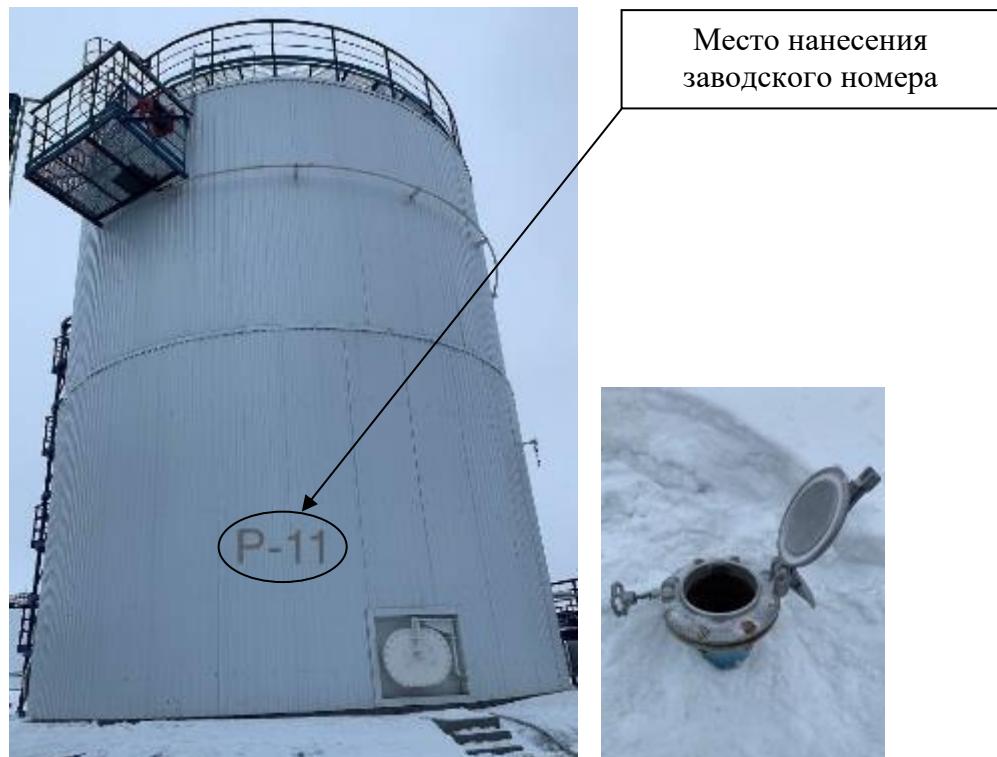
Общий вид резервуара с заводским номером Р1 и его замерного люка
